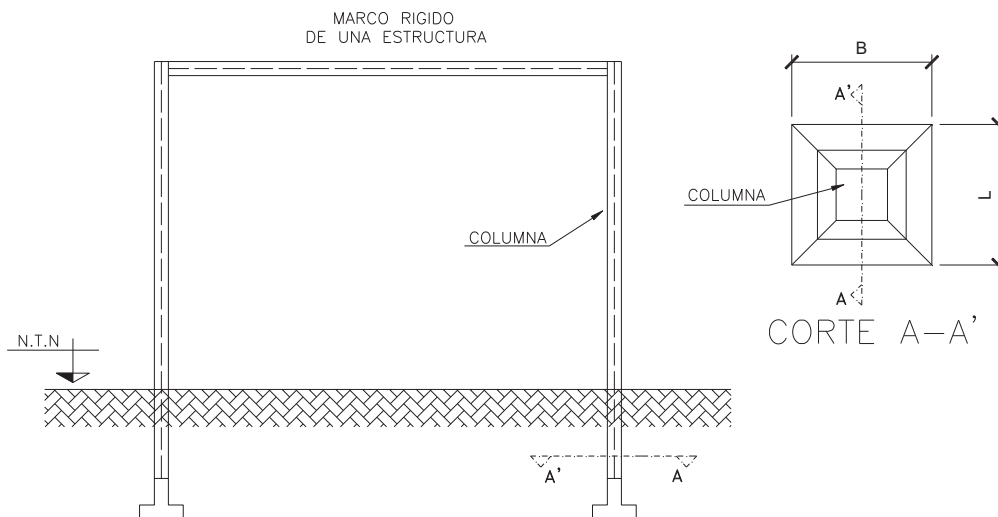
Marco de Una Estructura Cimentado Con Zapatas Aisladas
